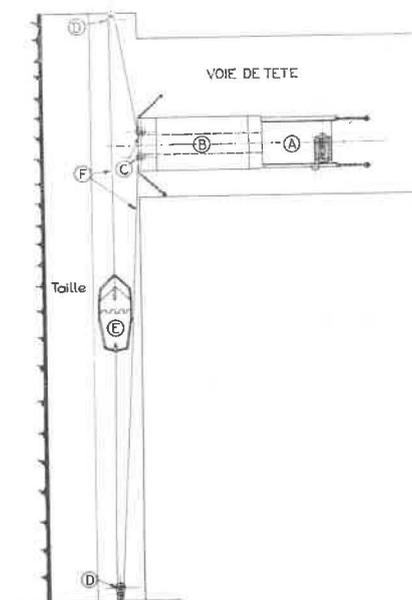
Vue d'ensemble d'une installation de remblayage par scraper.
